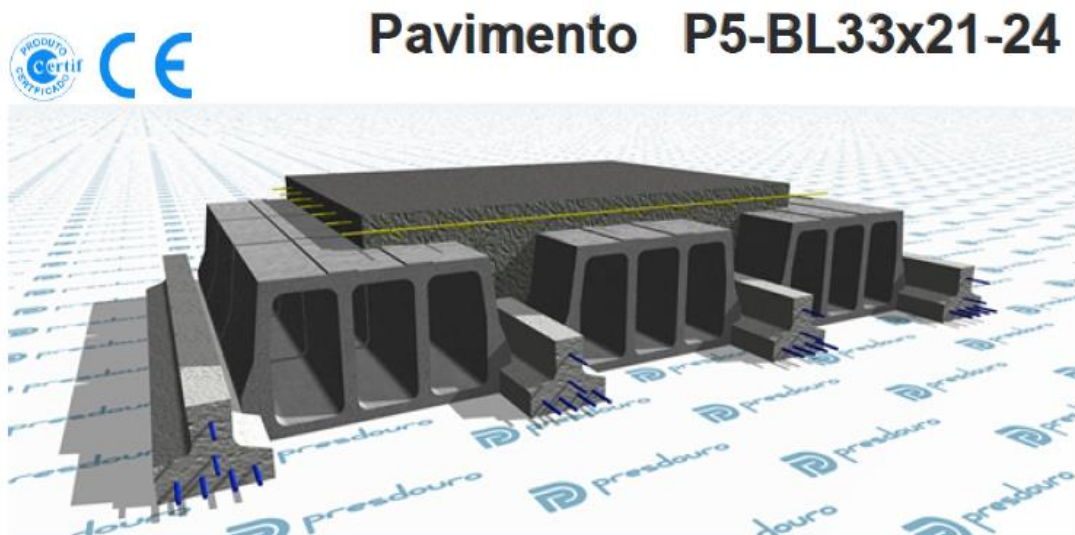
Solução da laje aligeirada de vigotas pré-esforçadas (2)
